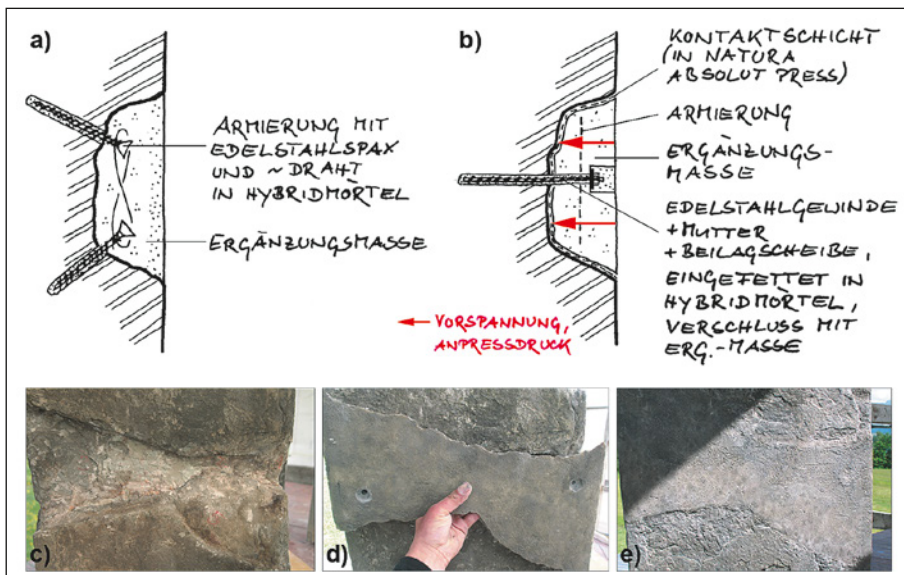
a) Herkömmliche Ergänzung mit Restauriermörtel sowie Schrauben- und Draht-
